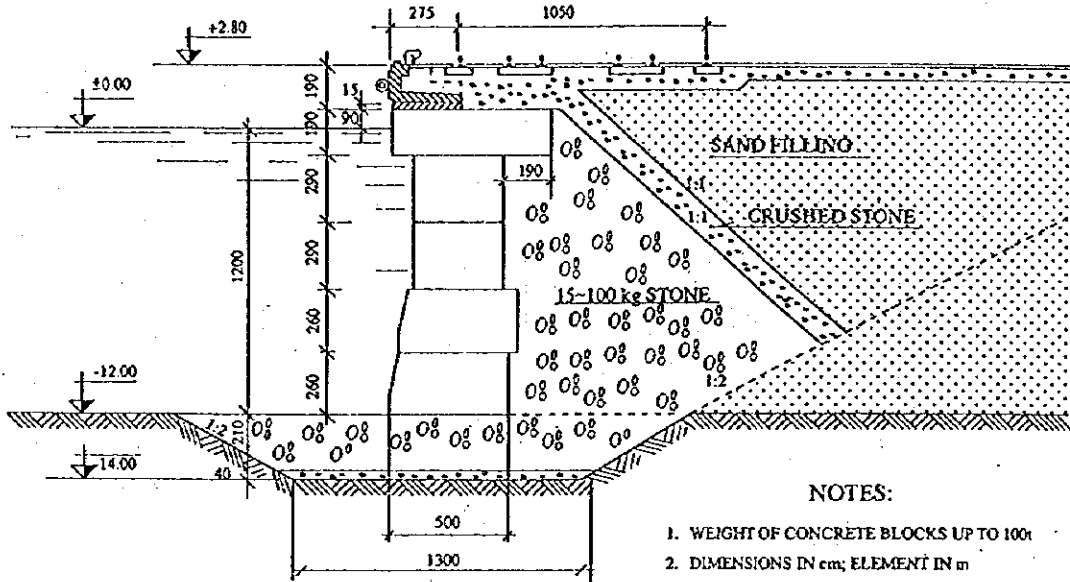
岸壁標準断面図-重力式 (-12.0m)
